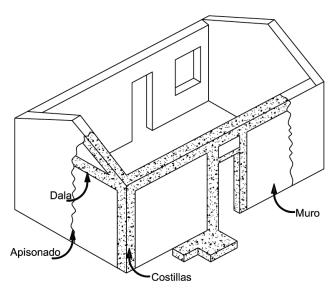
Refuerzo con vigas y columnas de concreto. Ídem, 7.
